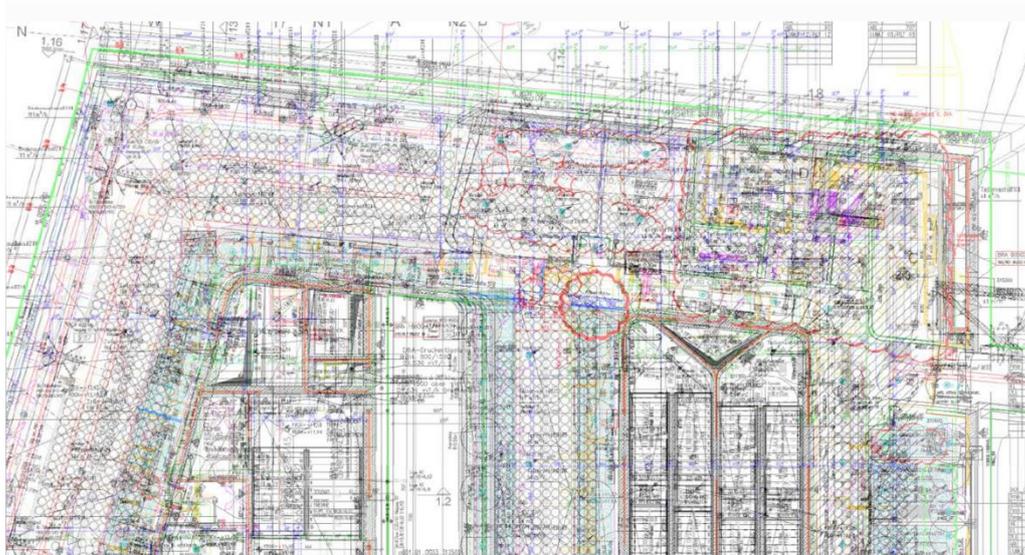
Grundriss des WU Campus<sup>52</sup>
